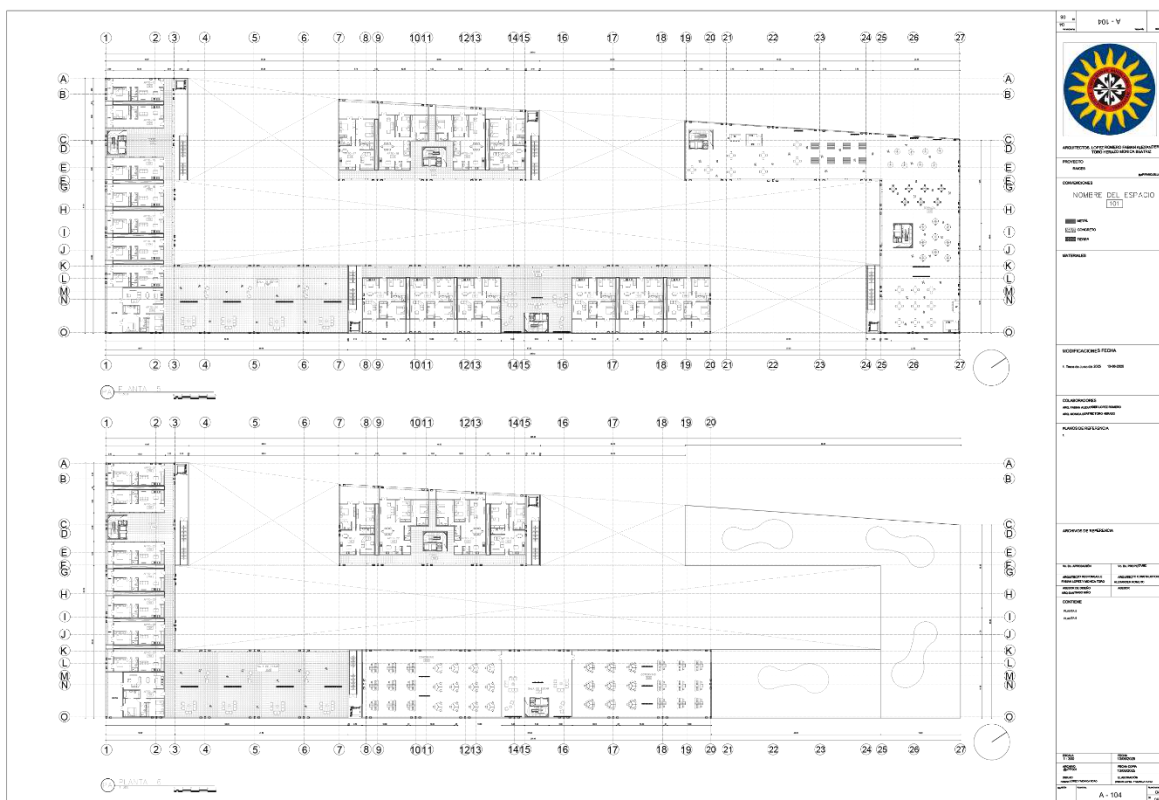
Planimetría Planta 5-6. Fuente: Elaboración propia.
